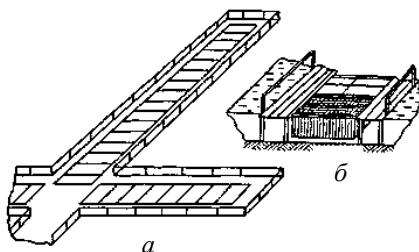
Стационарные садки: *a* – общий вид; *б* – установка садков на сваях
